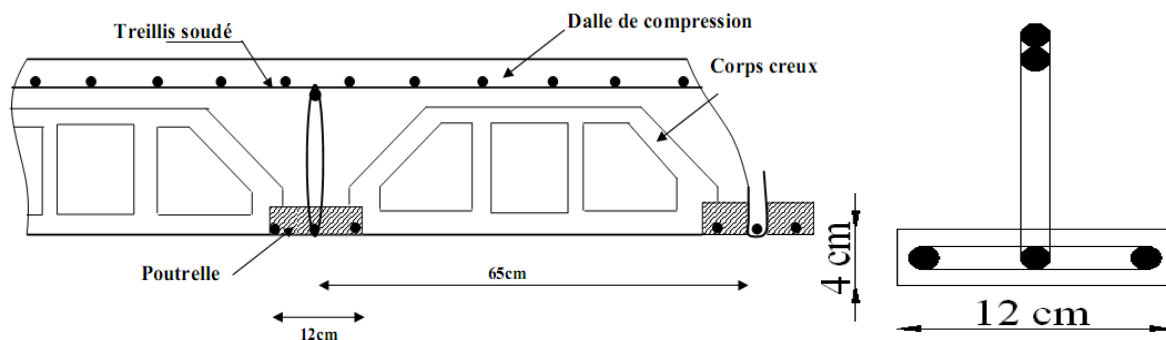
Coupe verticale d'un plancher en corps creux. Fig.III.2.2 : poutrelle.
